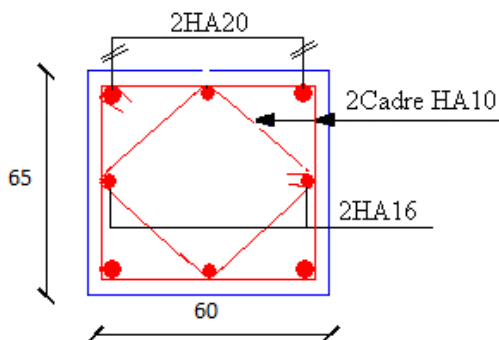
Schéma du ferrailage des poteaux 1^{ère} entre sol et RDC)
